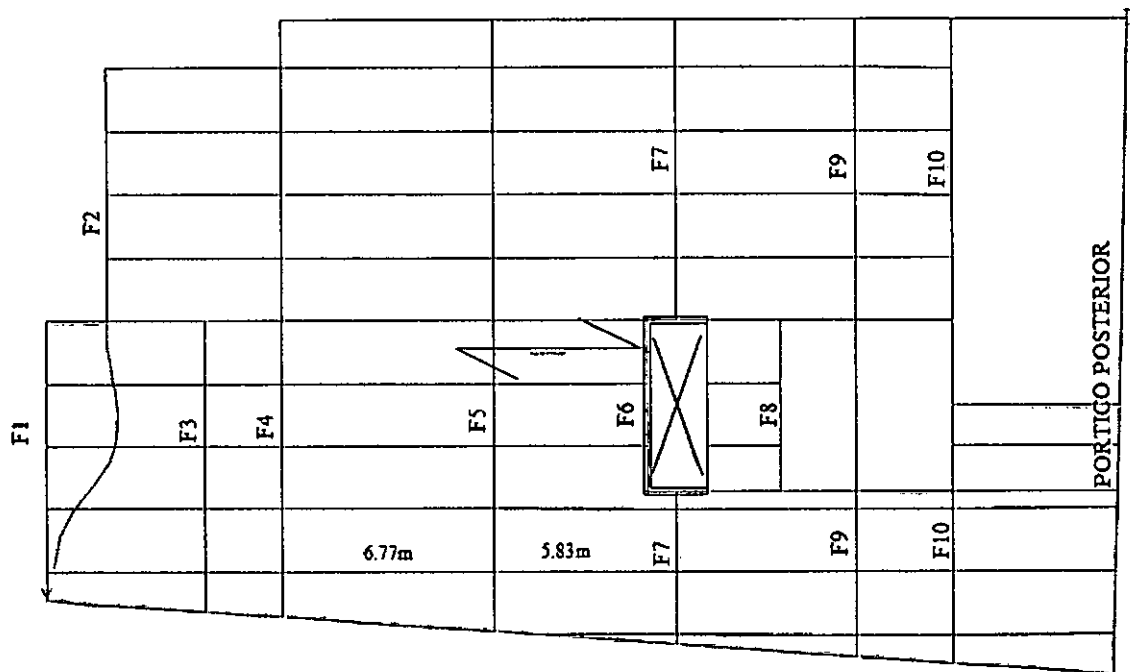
Ubicación en planta de los porticos transversales que conforman la estructura
